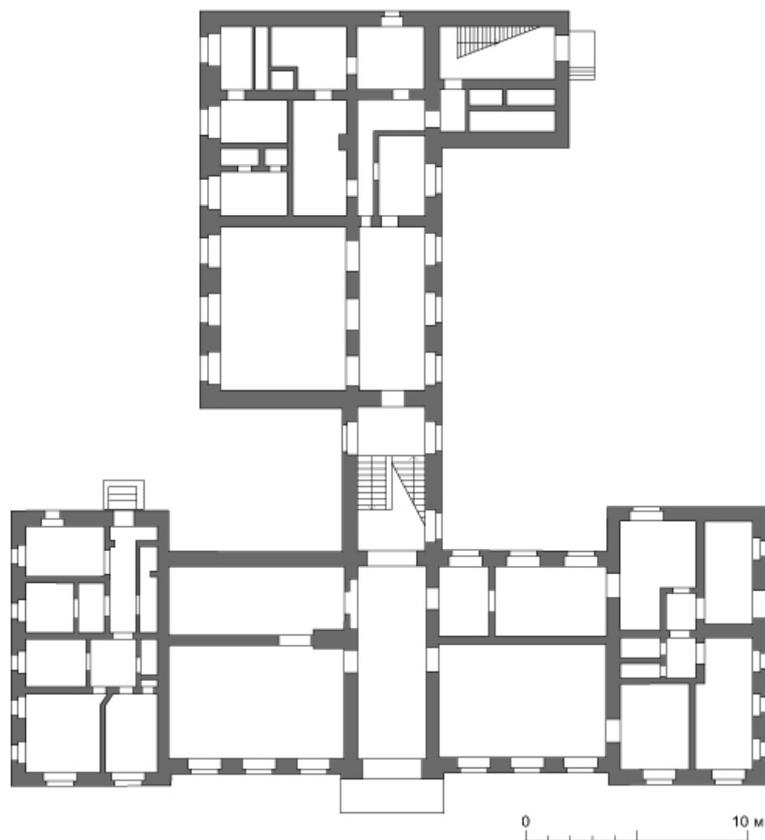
Здание Женской гимназии. План первого этажа.
